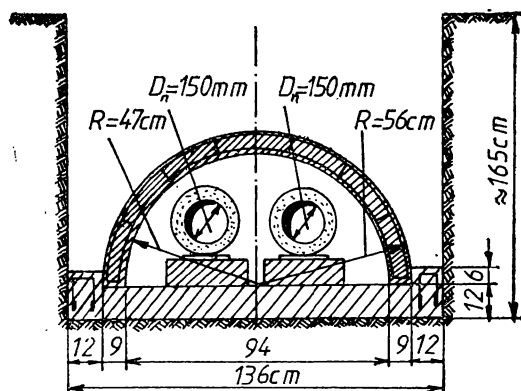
Secțiune printr-un canal de protecție acoperit cu placă în formă de boltă (bolțari).
